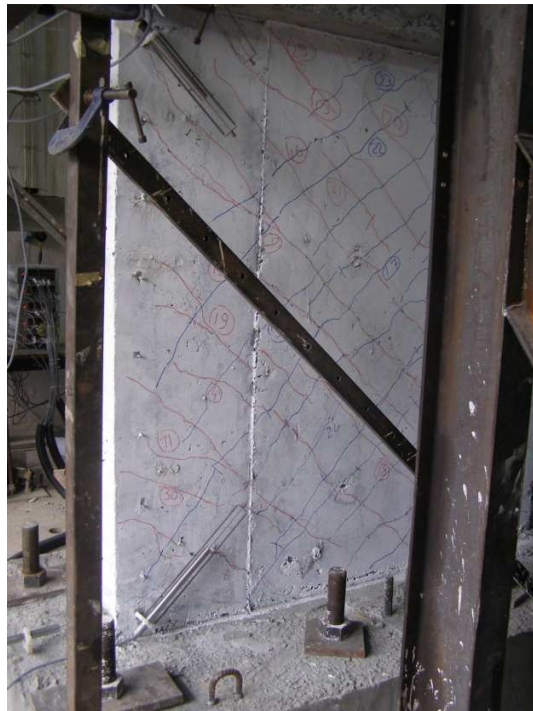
Patrón de fisuras en estado último de carga en muro SW-T6-S1-8 (Terzioğlu, 2011).
